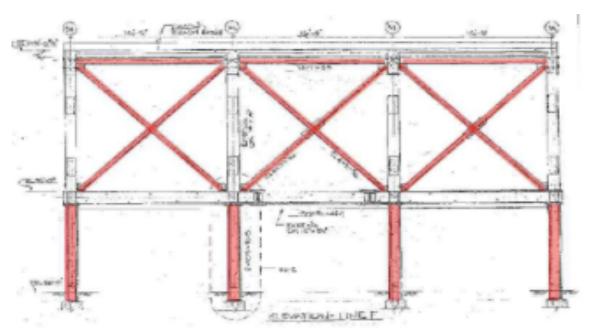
Arriostramiento de pórticos. (fuente: Evaluación, reparación y rehabilitación de estructuras de concreto)
